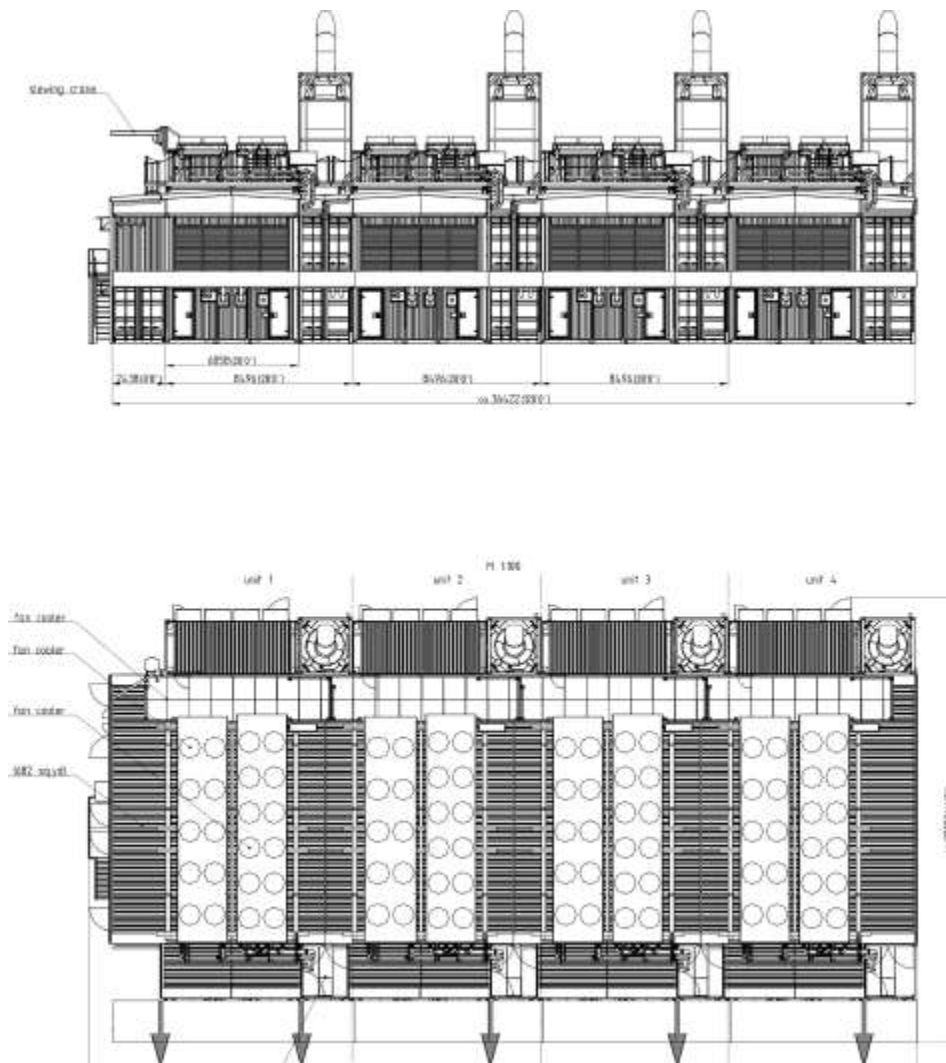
Layout Planta de generación usando Motores MWM TCG 2032 Modular Power Plant.
